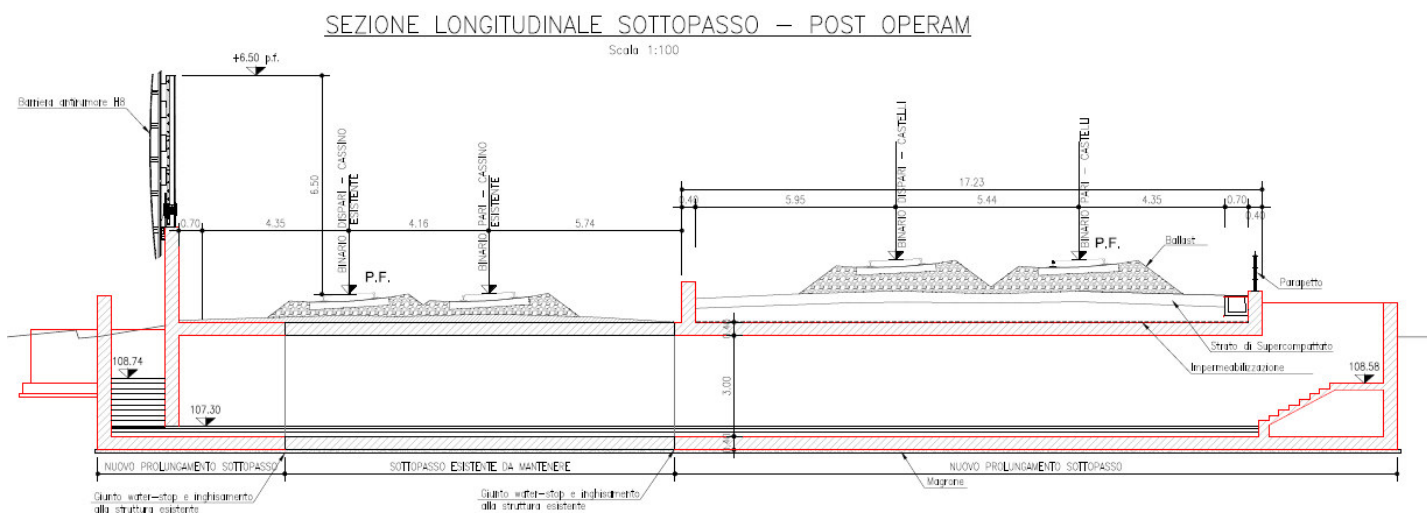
sottopassaggio esistente da prolungare SL08 – sezione trasversale
